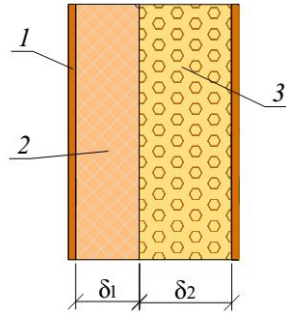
Стена из газобетонного блока, с наружным утеплением и штукатурным слоем: 1 – штукатурный слой; 2 – теплоизоляция; 3 – газобетонные блоки
